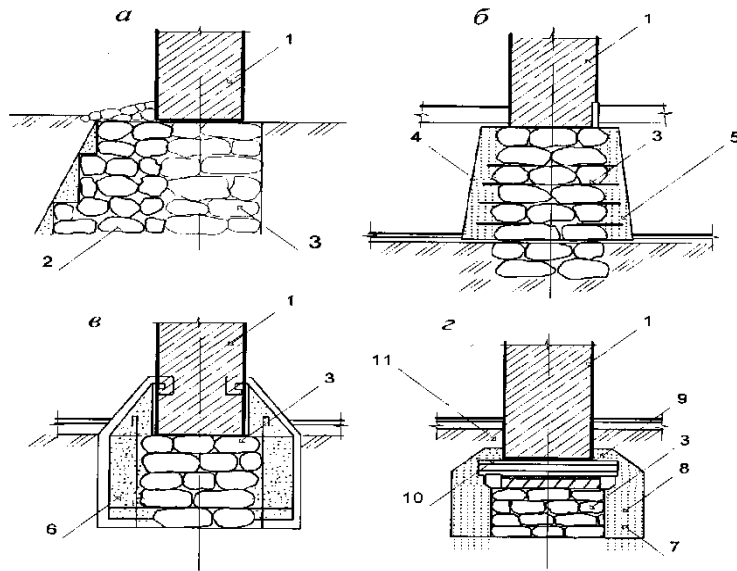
Традиційні технології підсилення фундаментів: а – додаткова кладка вперев'язку; б, г – бетонними обоймами; в – залізобетонними обоймами; 1 – стіна; 2 – нова кладка вперев'язку зі старою; 3 – стара кладка; 4 – металеві штирі; 5 – бетонна обойма; б – залізобетонна обойма; – щербенева підготовка; 8 – бетонні банкетки; 9 – робоча балка; 10 – розподільна балка; 11 – зачеканка литим бетоном
